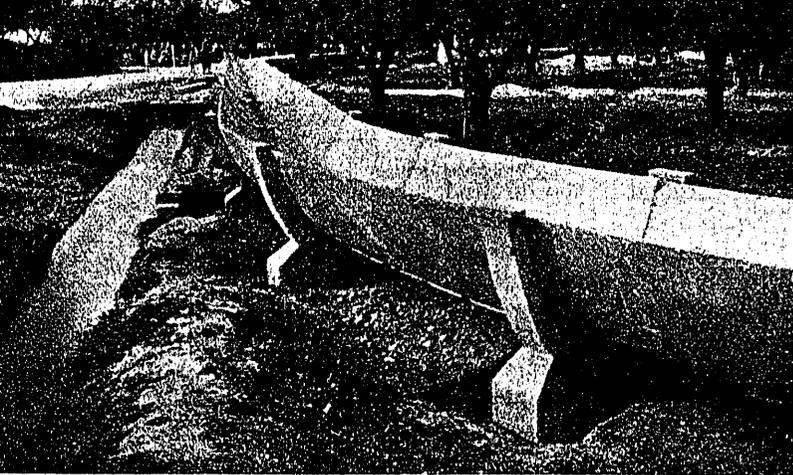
Acequia prefabricada de la zona de Perragoux.
